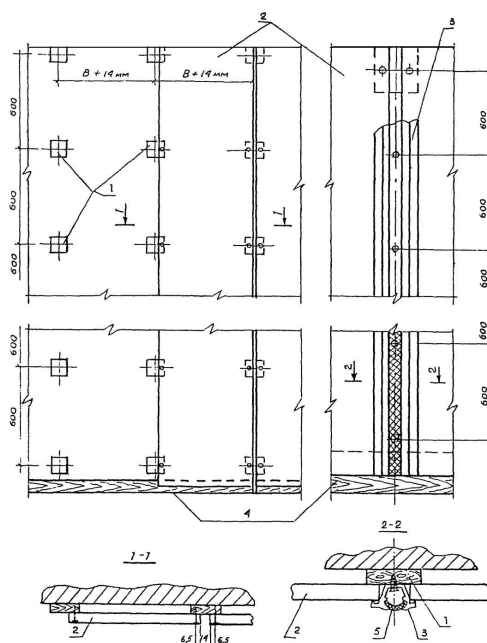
Схема разметки и установки опорных элементов для крепления каркаса:
